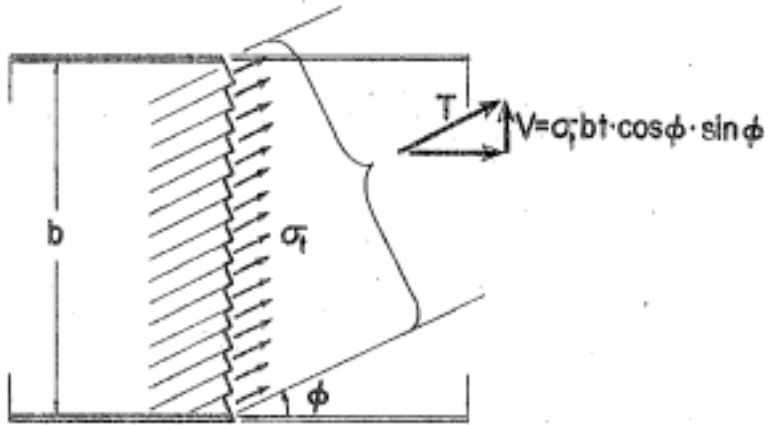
Distribución uniforme del campo de tensiones. (Fuente: Extracto de la Fig. 2 a) del documento “Strength of plate girders in shear”, Basler 1961)
